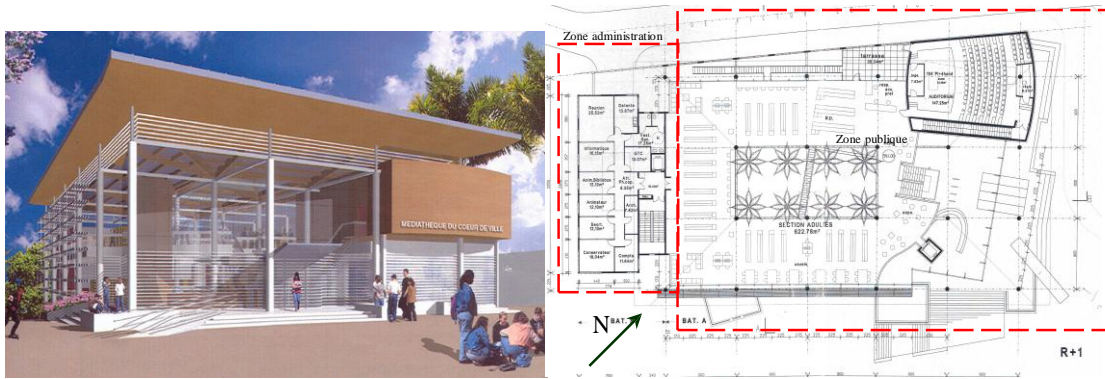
Bâtiment étudié : façade (Nord Est) et plan du niveau R+1
